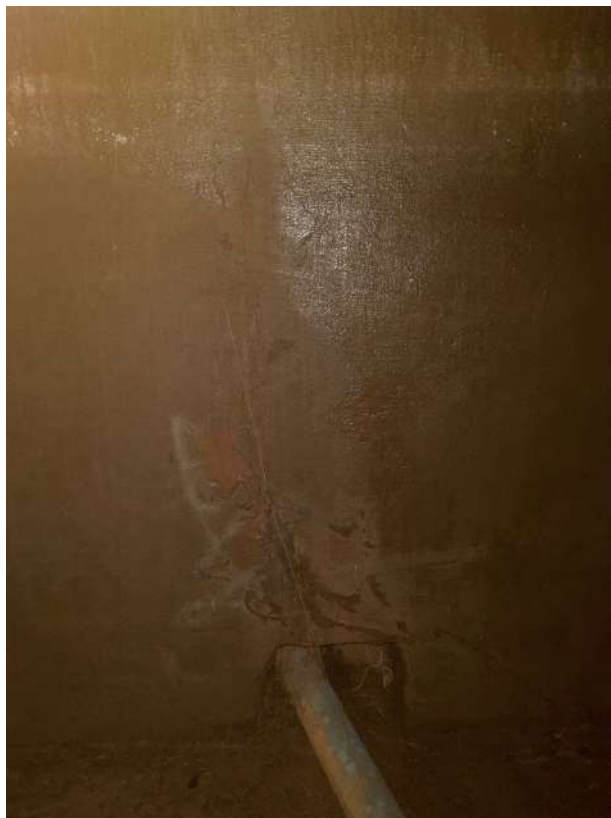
Interior da cisterna – Fissura na parede com crescimento de vegetação
